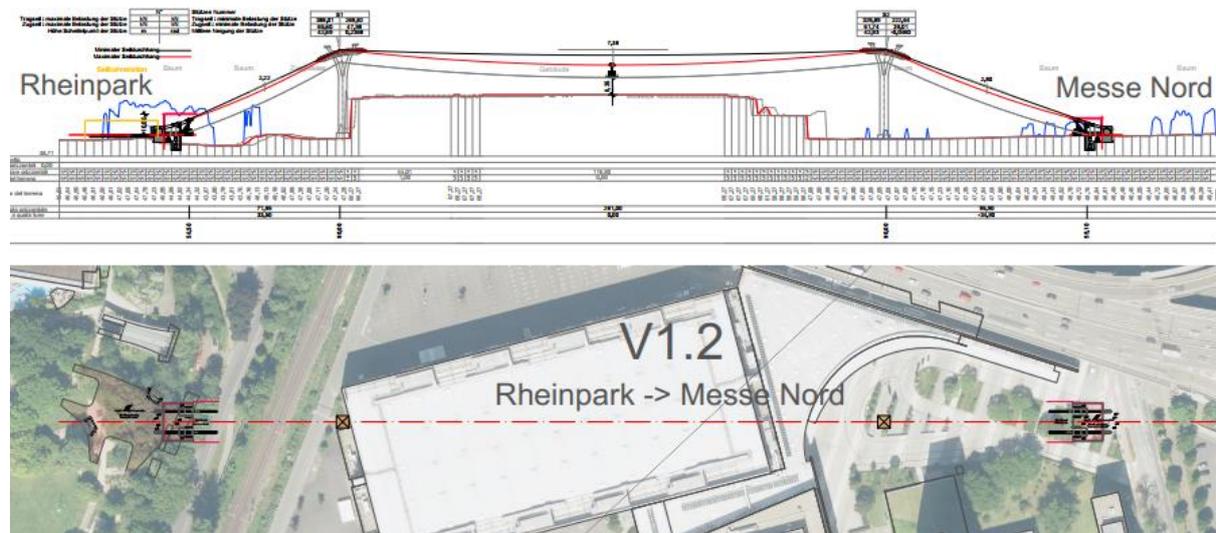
Längenschnitt, Lageplan Variante V1.2
